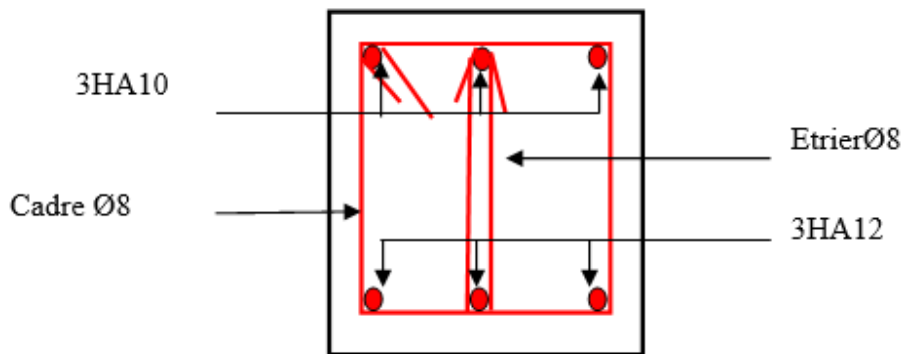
Schéma de ferrailage de la poutre de chaînage.
